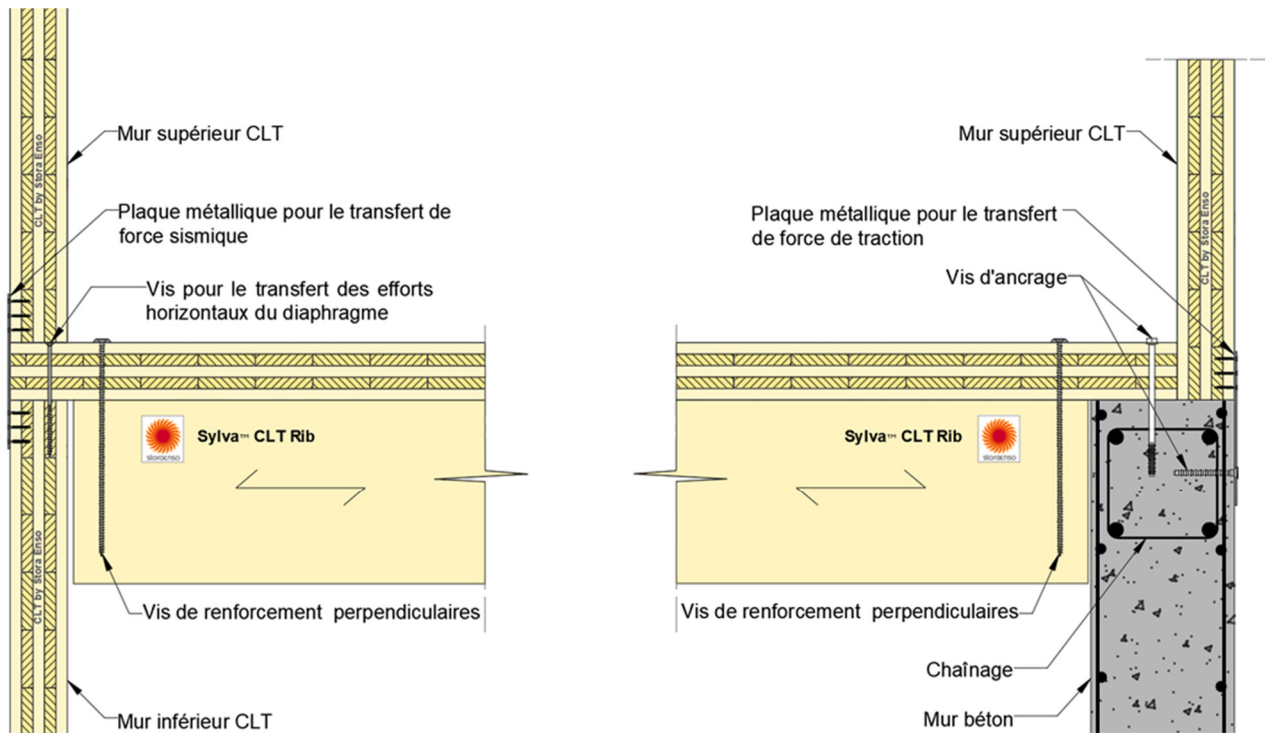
Exemple d'appui par la membrure CLT supérieure sur poutre muralière en liaison sur mur CLT et mur béton – Caisson ouvert
